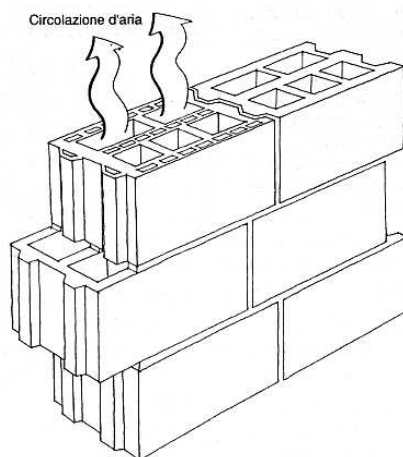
Esempi di elementi con canalizzazioni adatti per murature attrezzate
